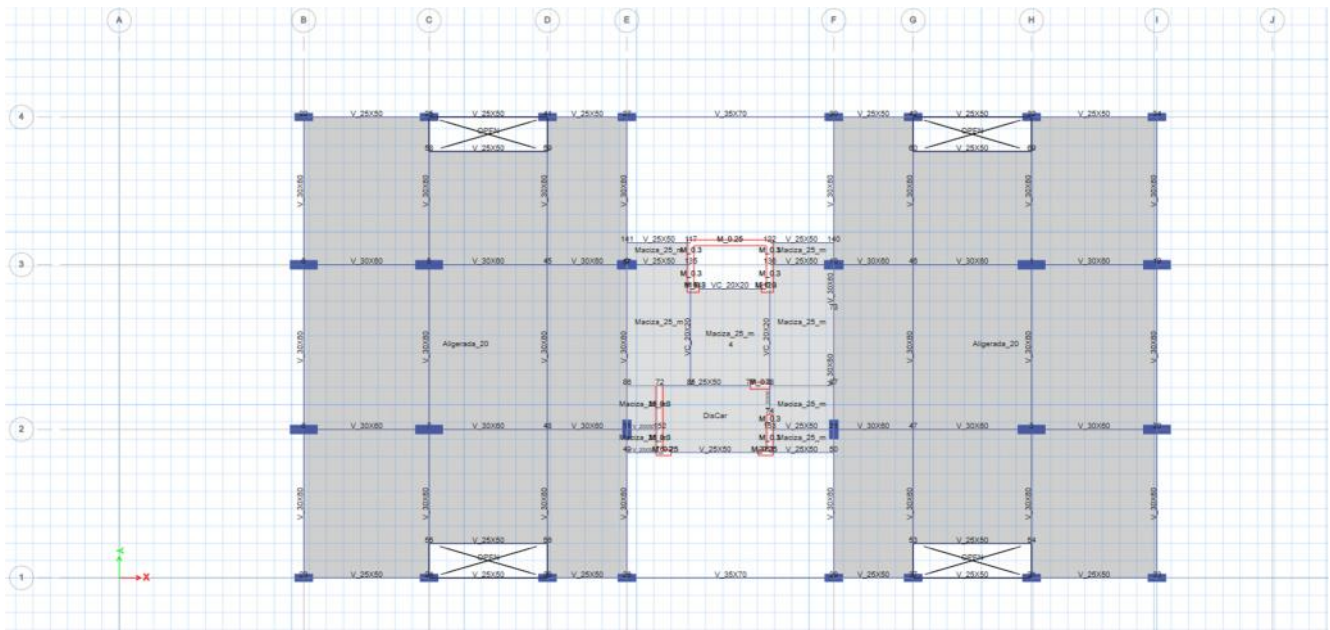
Vigas y Losas en Piso Típico 02 al 10
